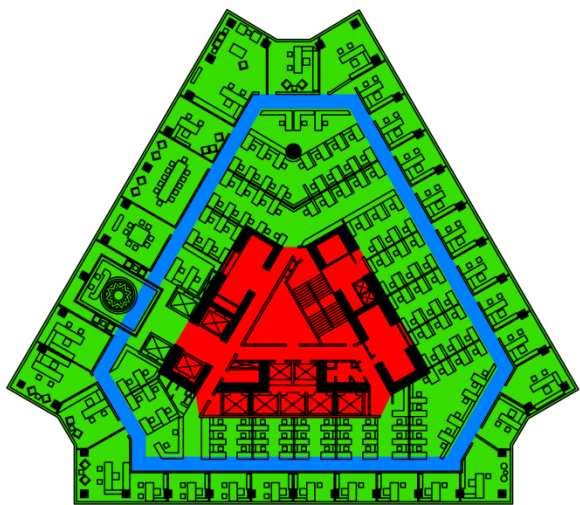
Análisis de Área Usable, Planta tipo Central Plaza.
